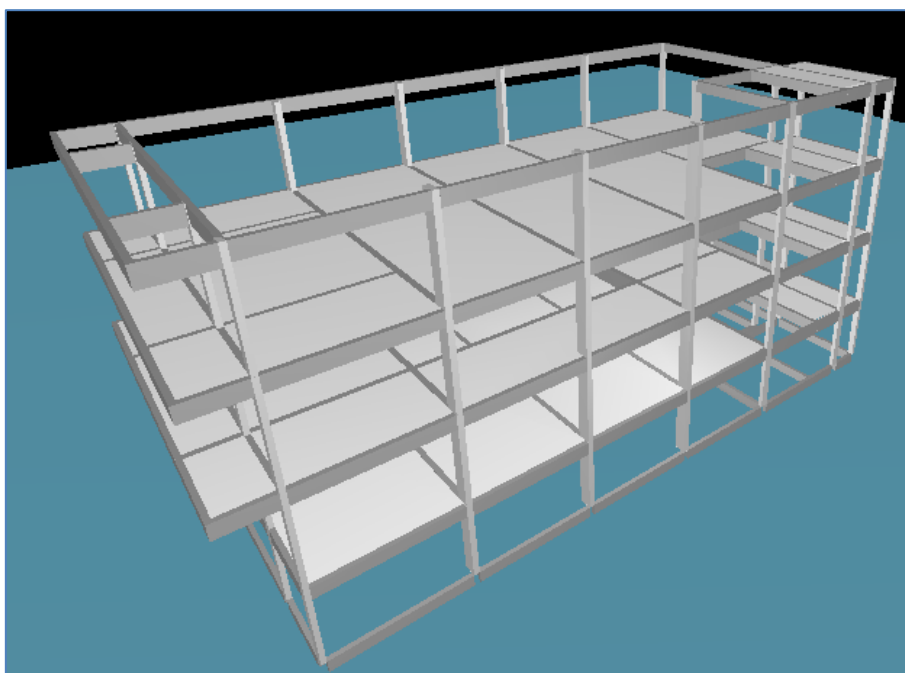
Modelo 3D: Estrutura em concreto armado (CAD/TQS).
